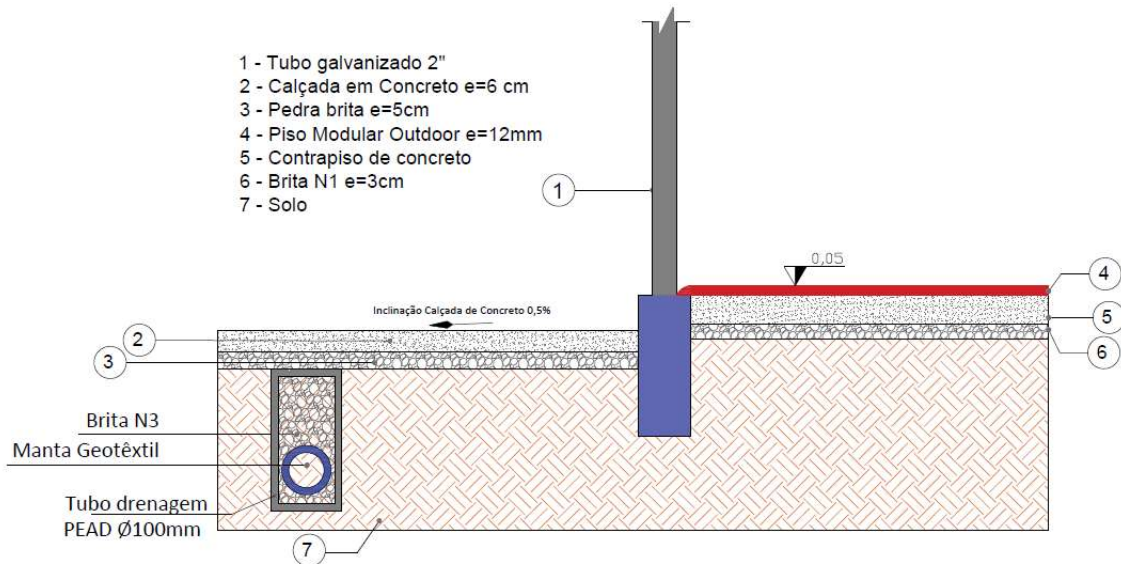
Detalhe tubo de drenagem (Fonte: Autor/2025)
